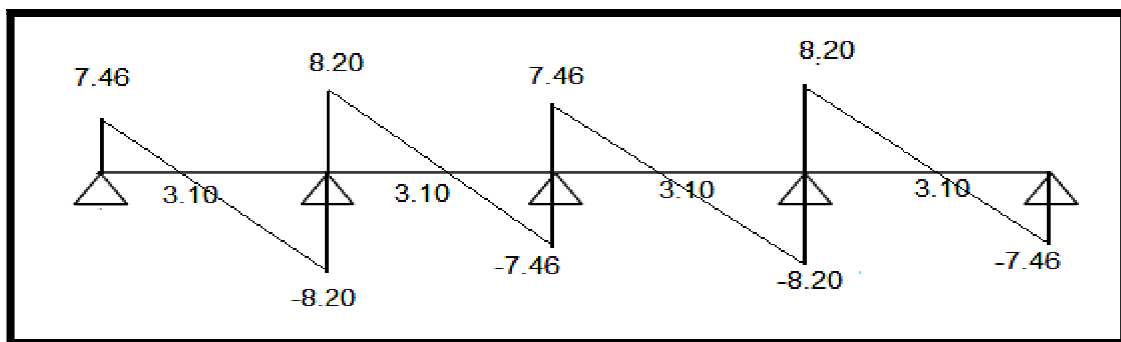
Diagramme des efforts tranchants à l'ELS des poutrelles du plancher terrasse inaccessible (type 4)
